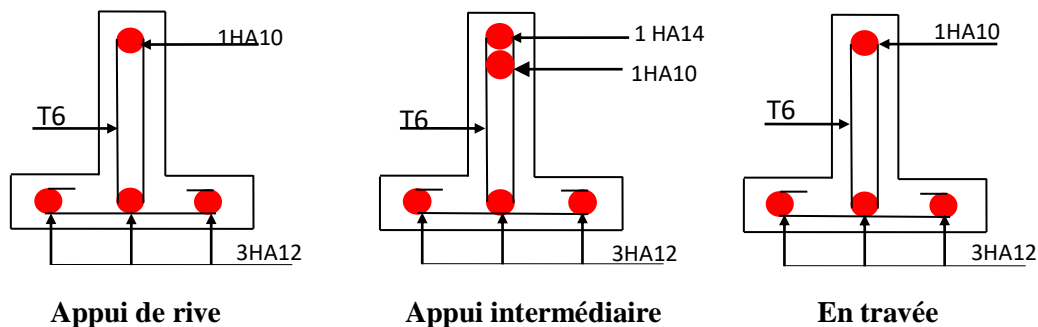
Ferrailage des poutrelles du plancher terrasse accessible
